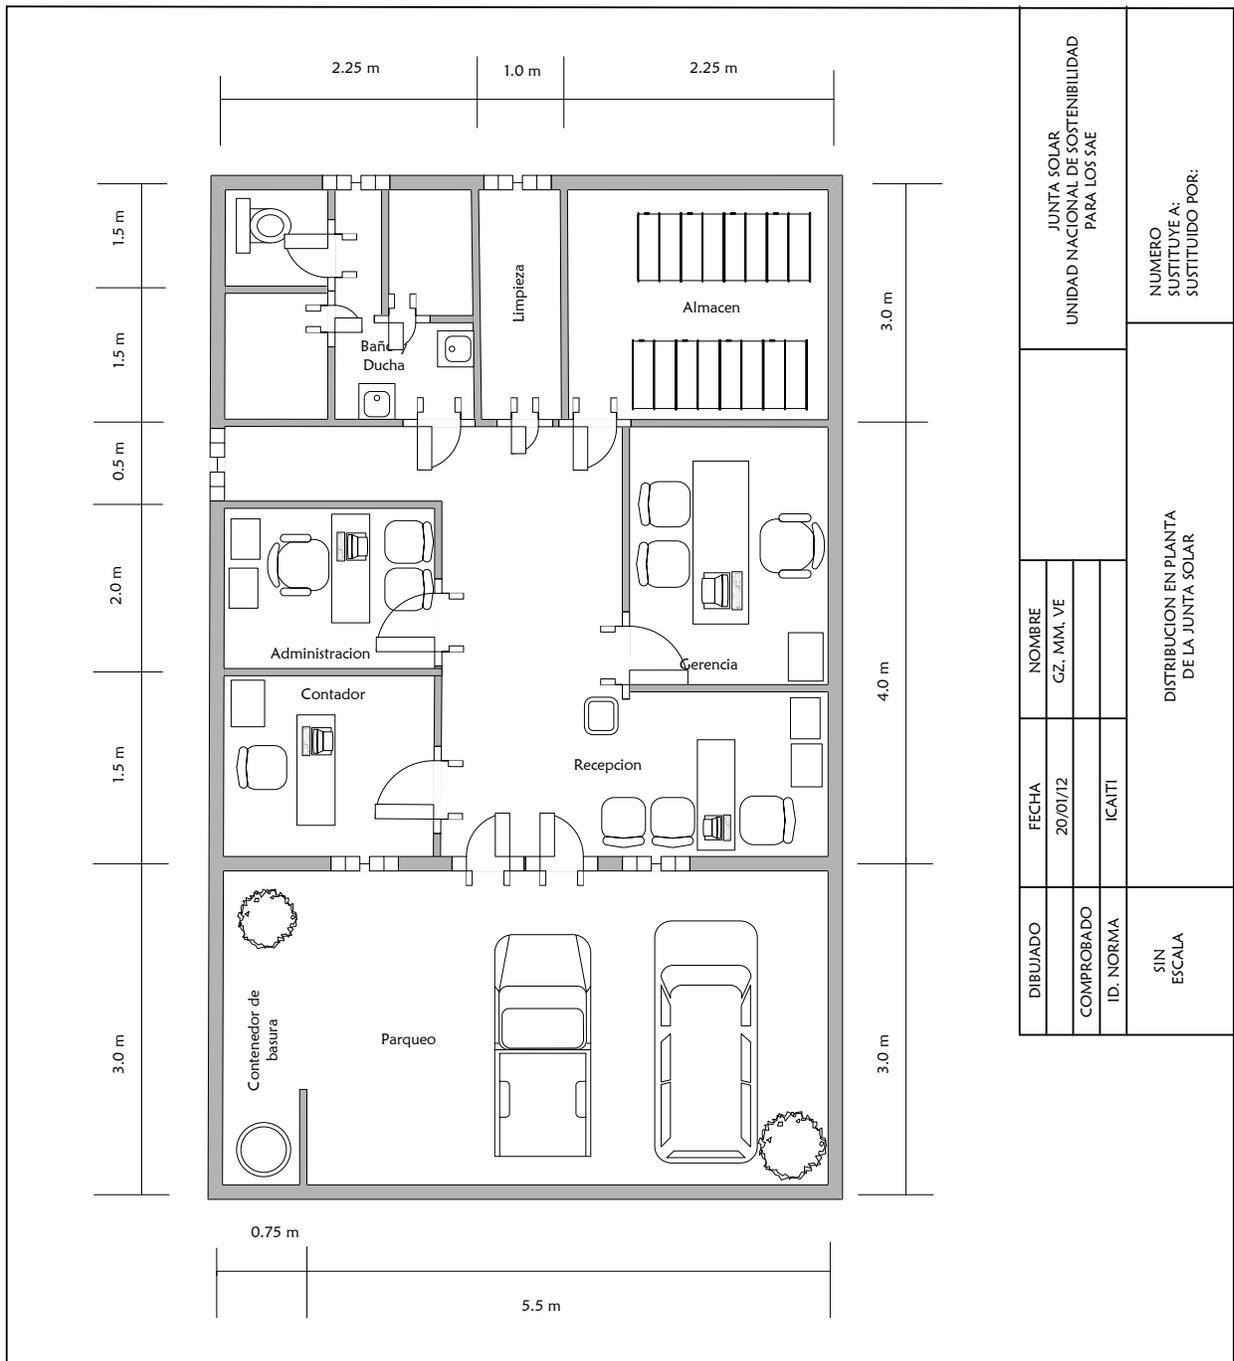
Distribucion en planta de la Junta Solar – Plano general
